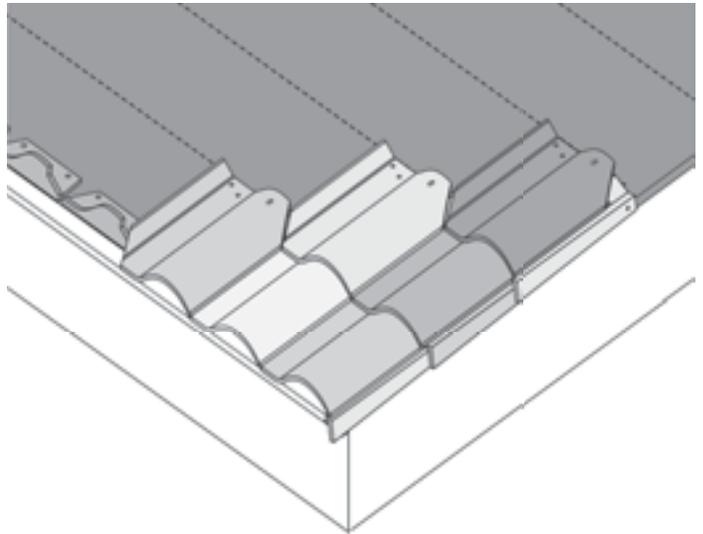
Secuencia de instalación para tejas de faldón 'Spanish' (Spanish Field Tile)
